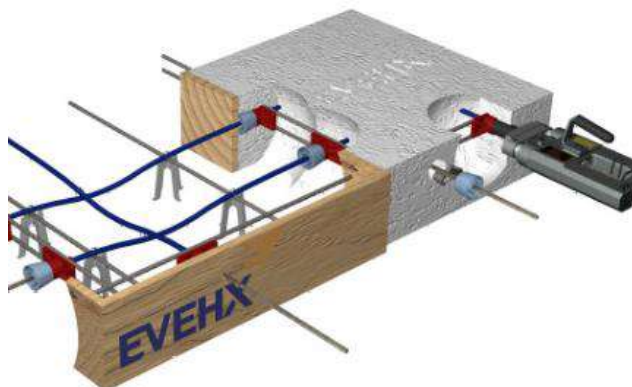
Sistema de cubierta, losa postensada. Fuente: ProMallas, 2022
